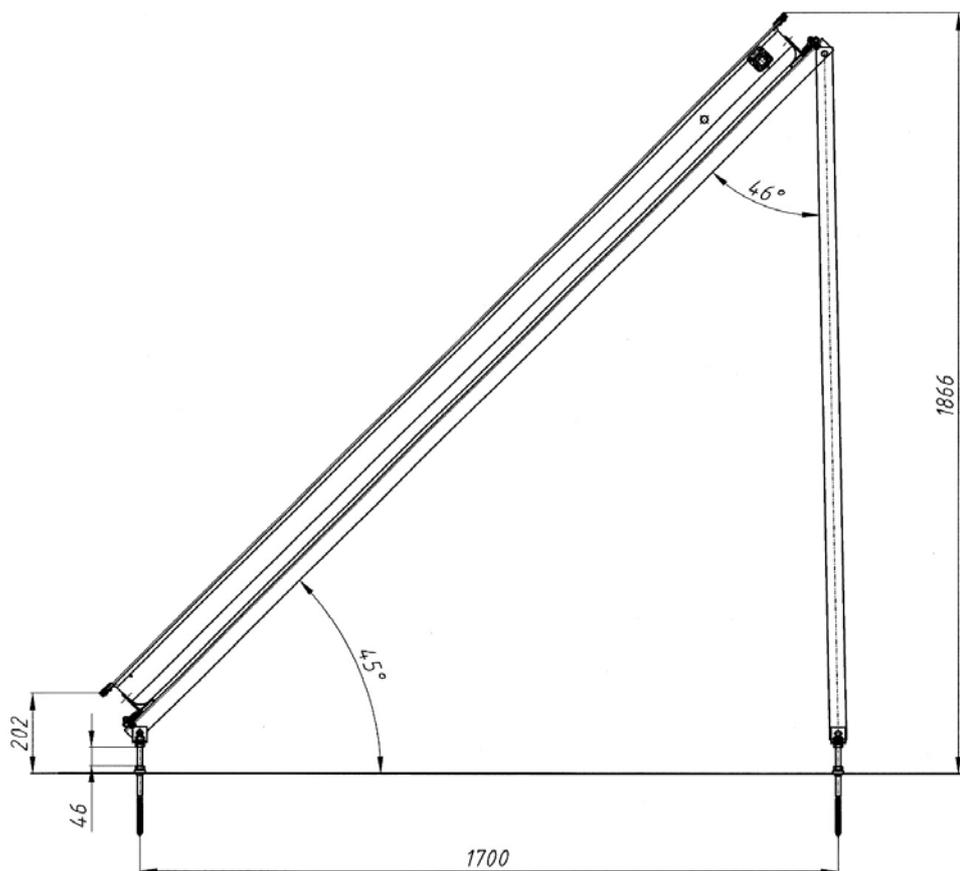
Exemple de support capteur (inclinaison à 45 °) pour implantation sur un plan horizontal
